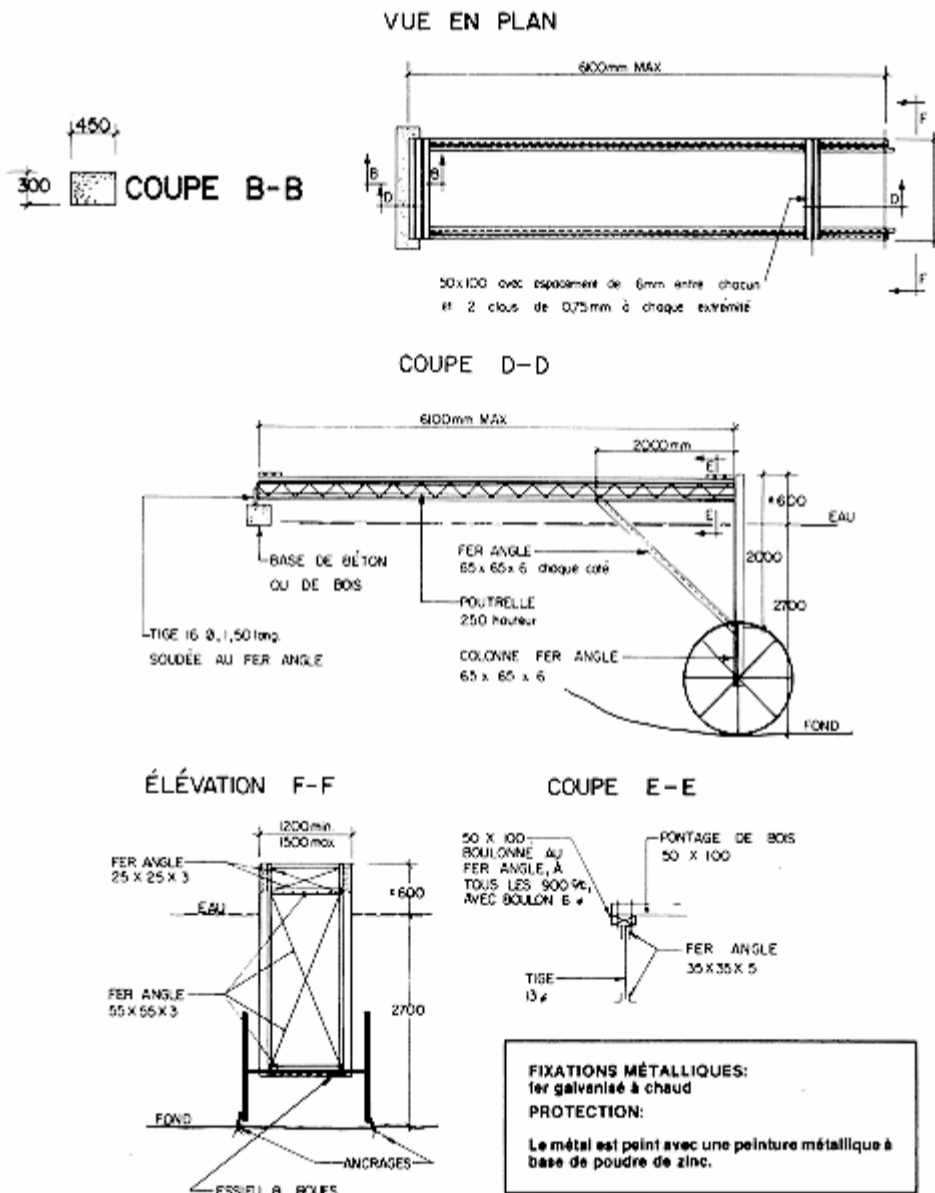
Embarcadère amovible roulant, construit sur place
